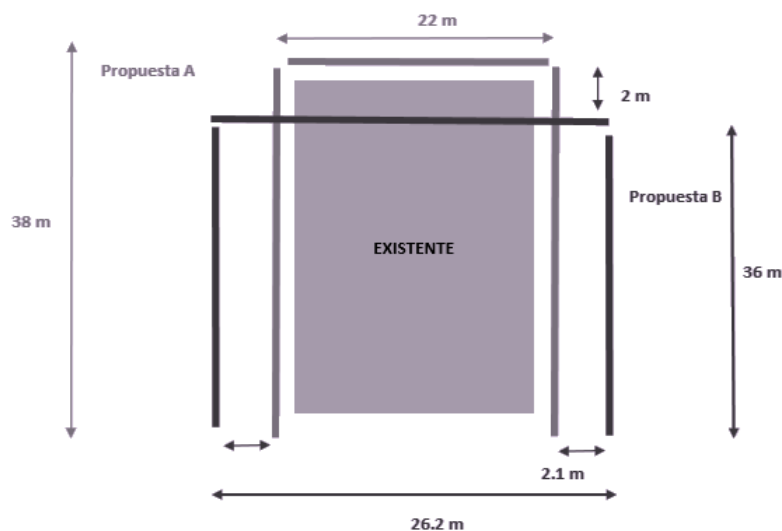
Planta Teatro Plaza de la Cultura Existente, Propuesta A, y B.
